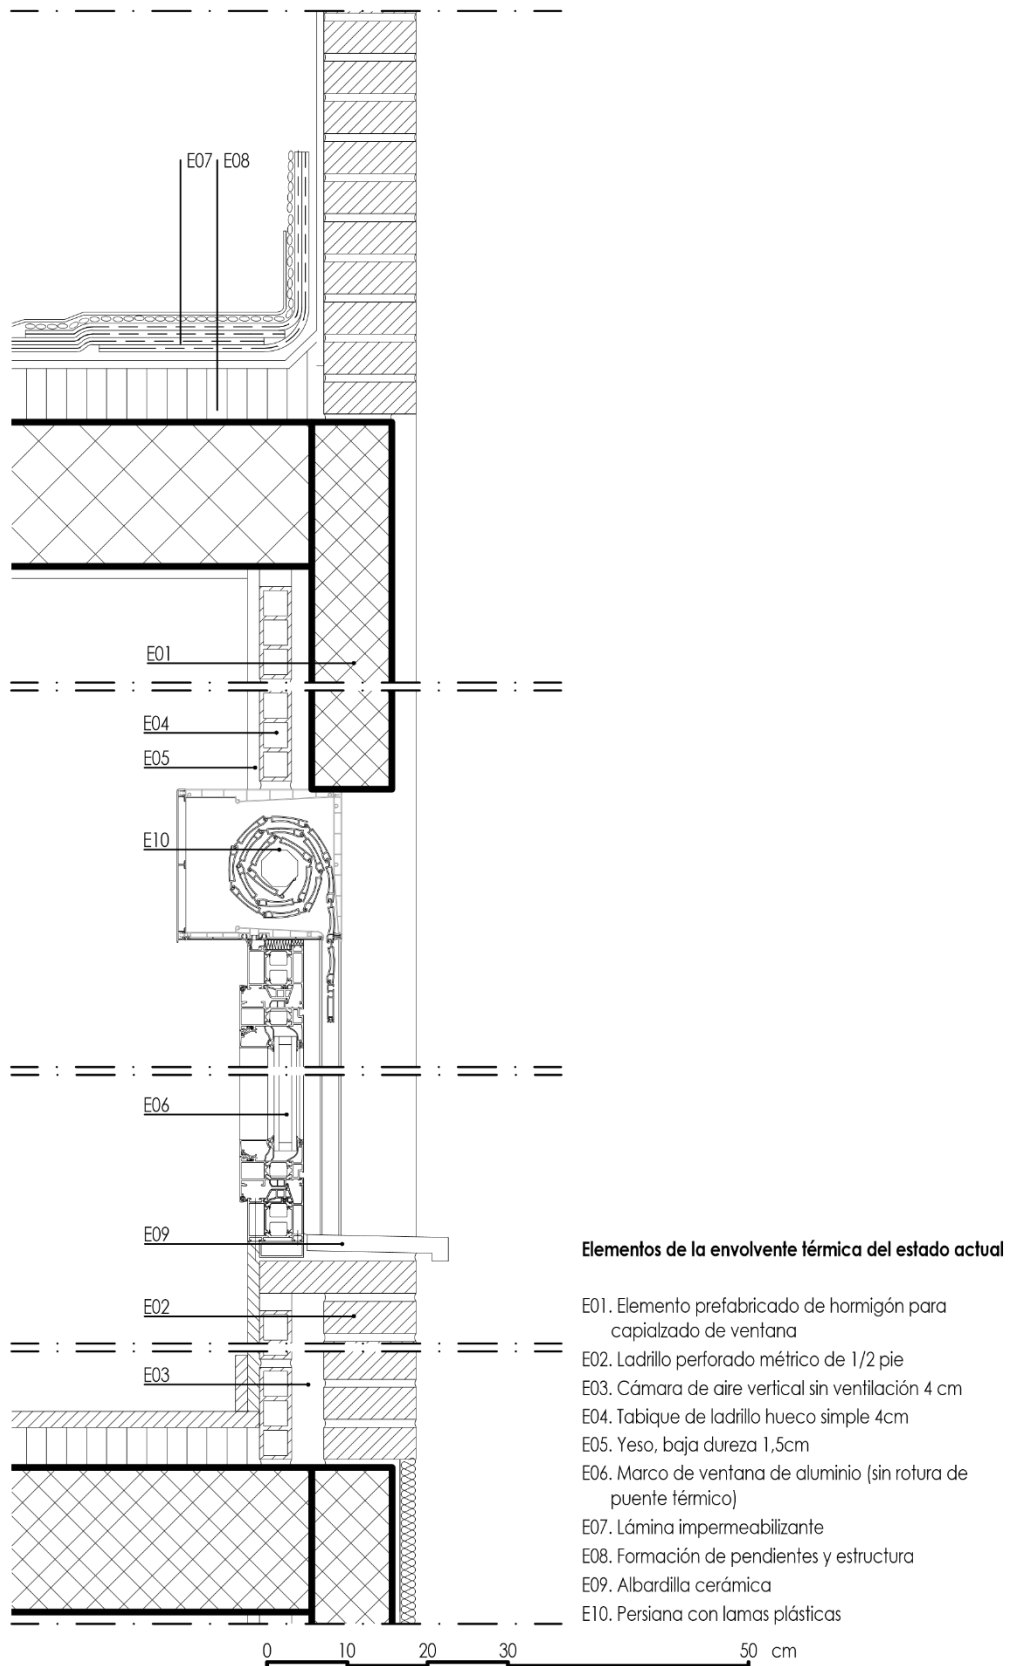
Sección constructiva de la envolvente. Fuente: Elaboración propia a partir de información original del proyecto.
